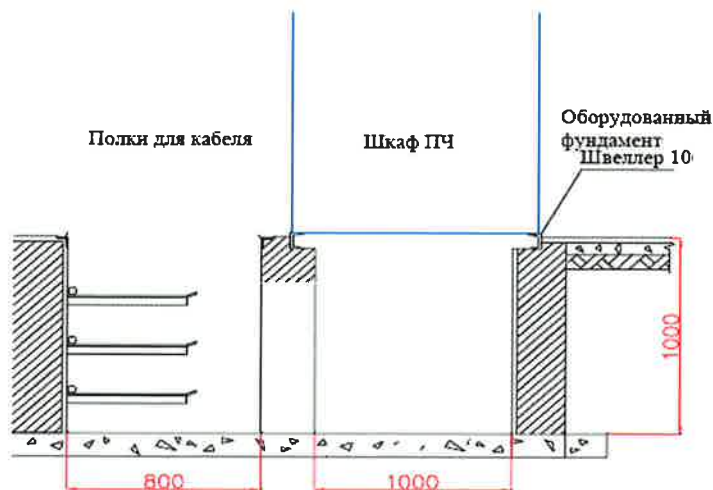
Установка шкафа ВПЧА на основание (фундамент)
